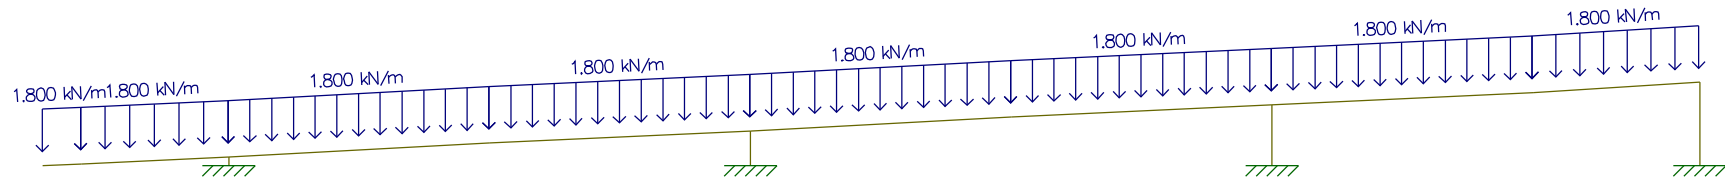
Reações da tesoura metálica na estrutura de concreto armado considerando os carregamentos reais da estrutura.
